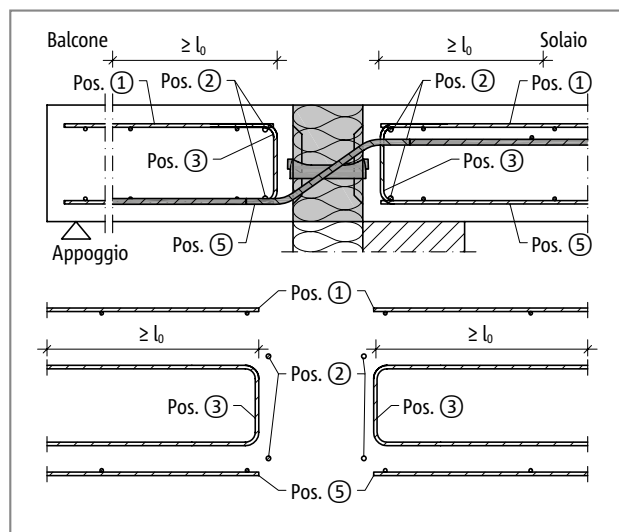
Schöck Isokorb® tipo da QXT60 a QXT90: armatura in opera
